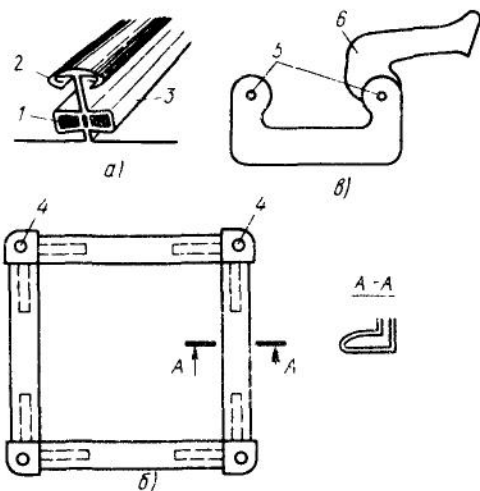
Бесфланцевые соединения прямоугольных воздуховодов:
